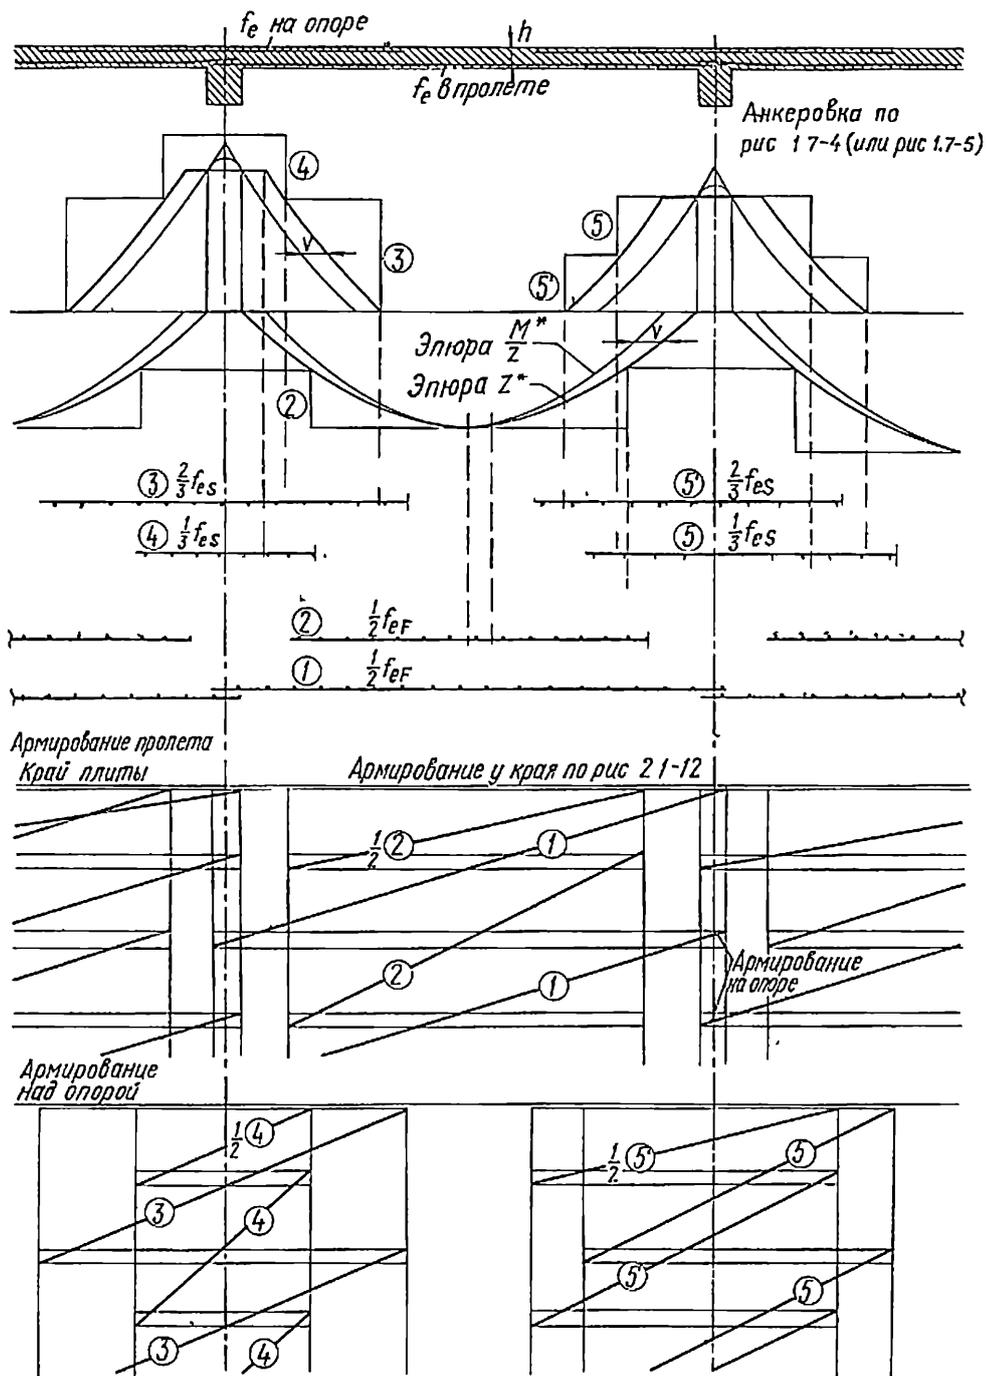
Армирование неразрезных плит: эпюра материала при армировании сетками
